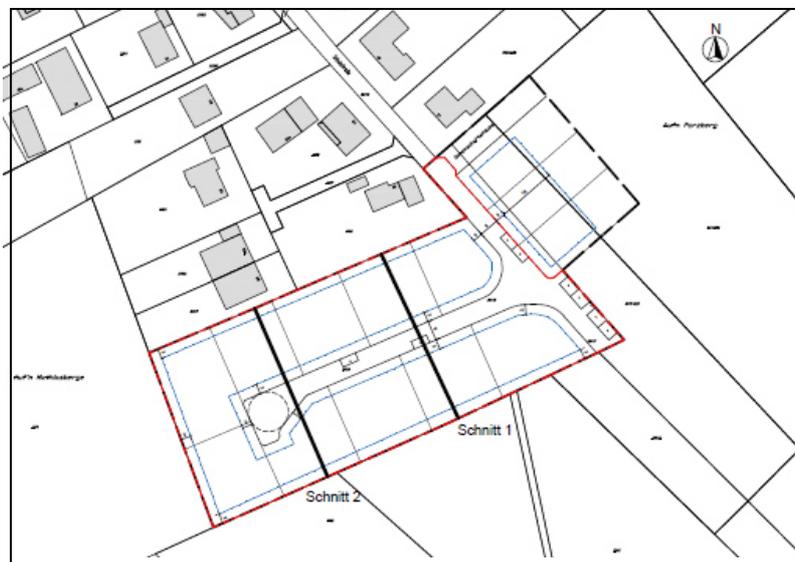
Lageplan mit Schnitt 1 und 2 (ohne Maßstab)
